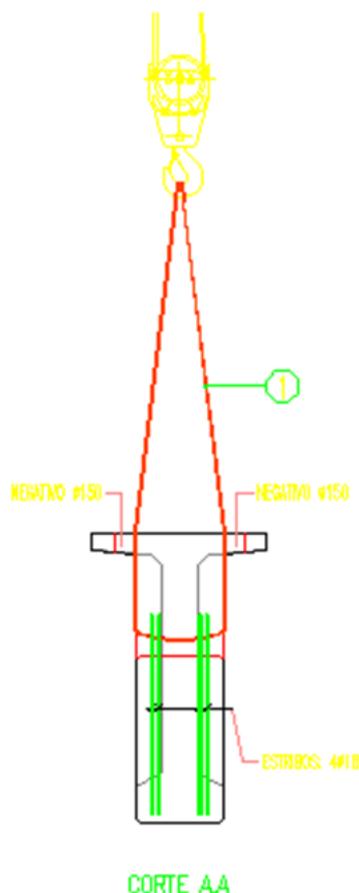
Esquema de elevação de uma viga (INDUBEL, S.A)
